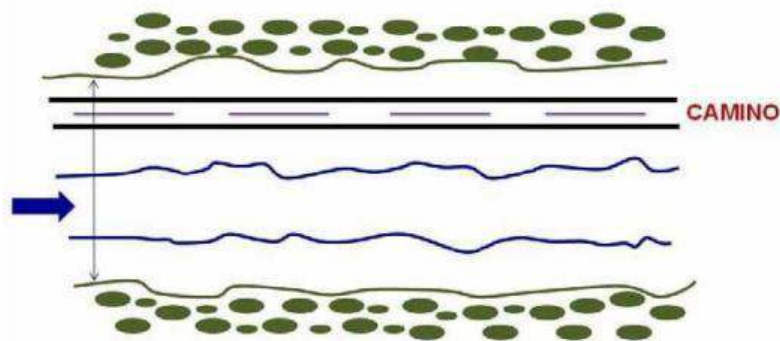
El camino construido dentro del cauce, paralelamente al río constituye una invasión vial longitudinal.
